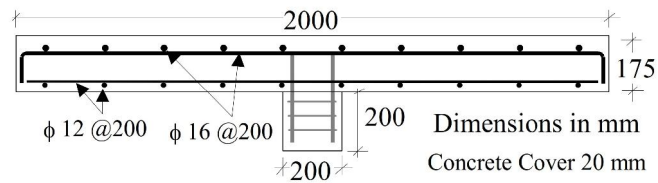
Pormenor da armadura de flexão e do pilar [54].
